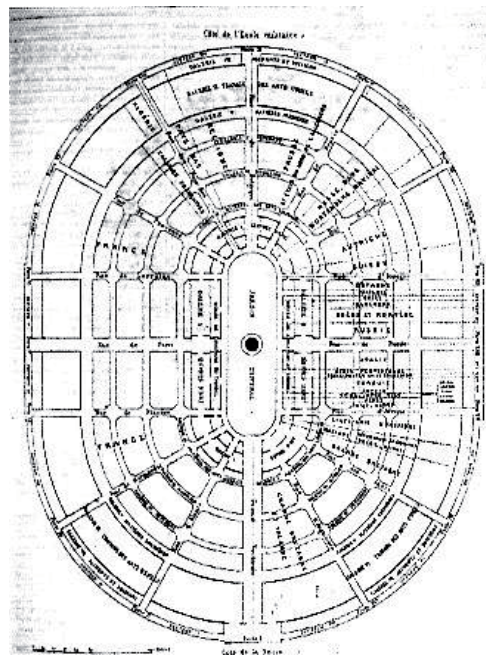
Planta do pavilhão principal da Exposição Universal de 1867, em Paris, França.
